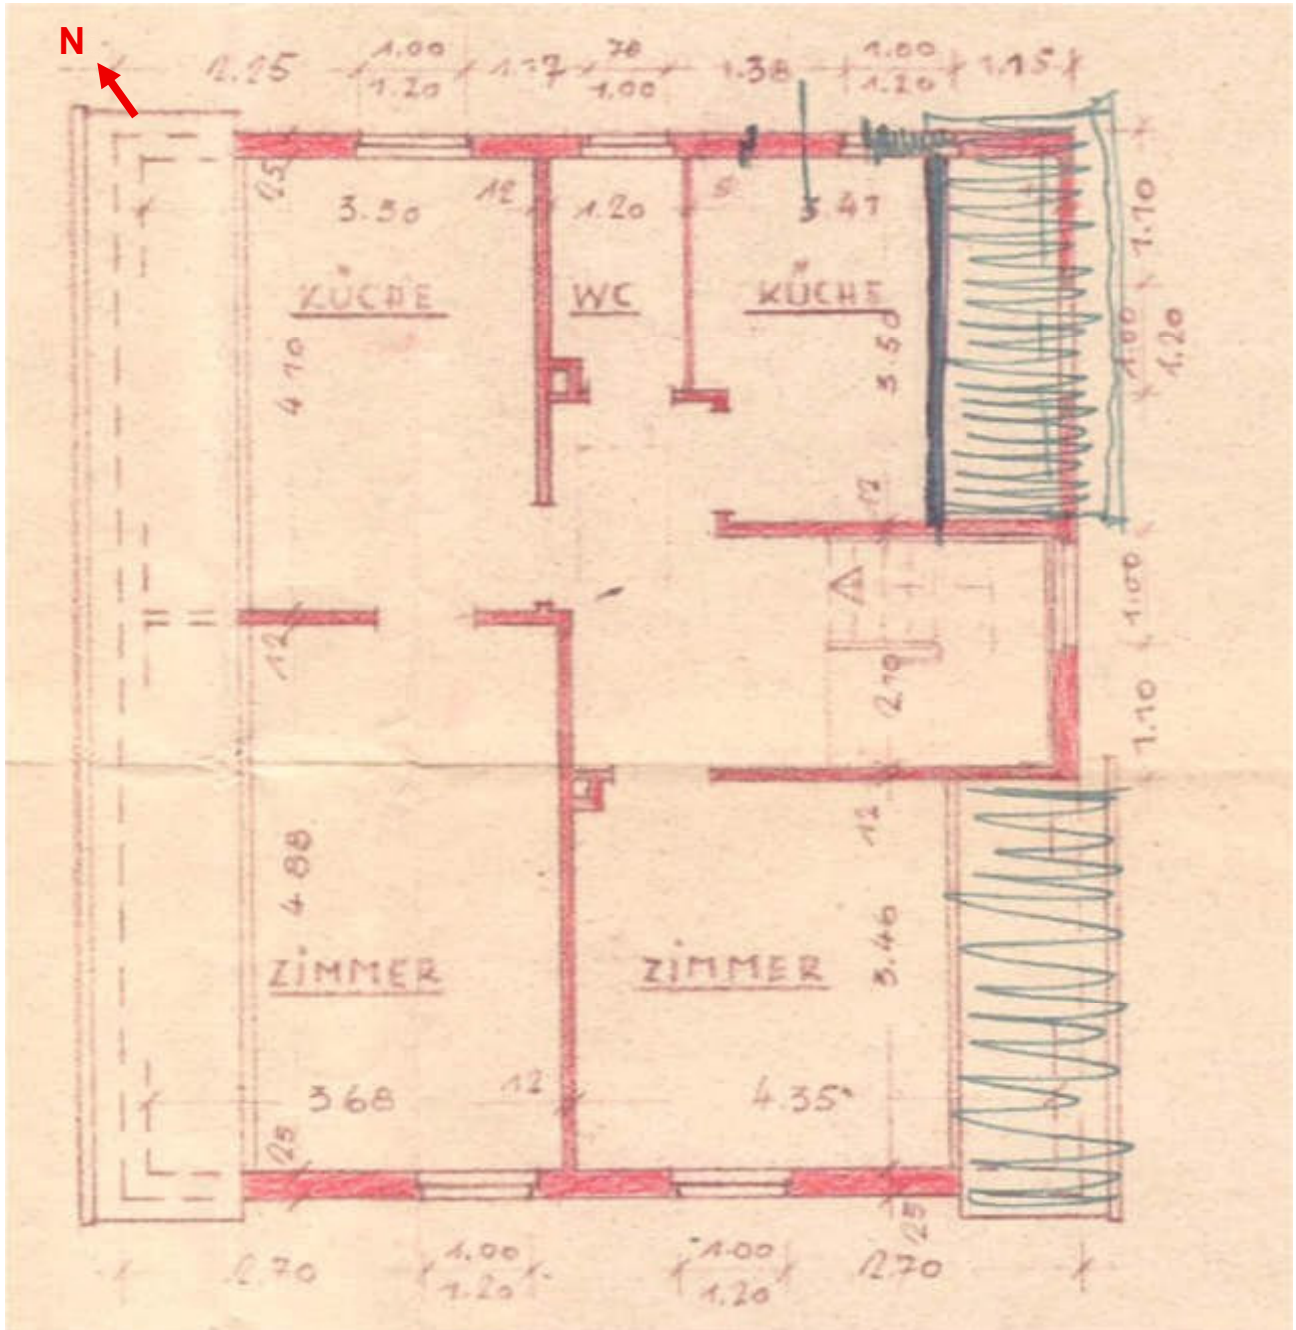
Grundriss Dachgeschoss (ohne Maßstab) 1951; Quelle: Bauakte Neubau eines Wohnhauses; Nordpfeil d.d. SV
